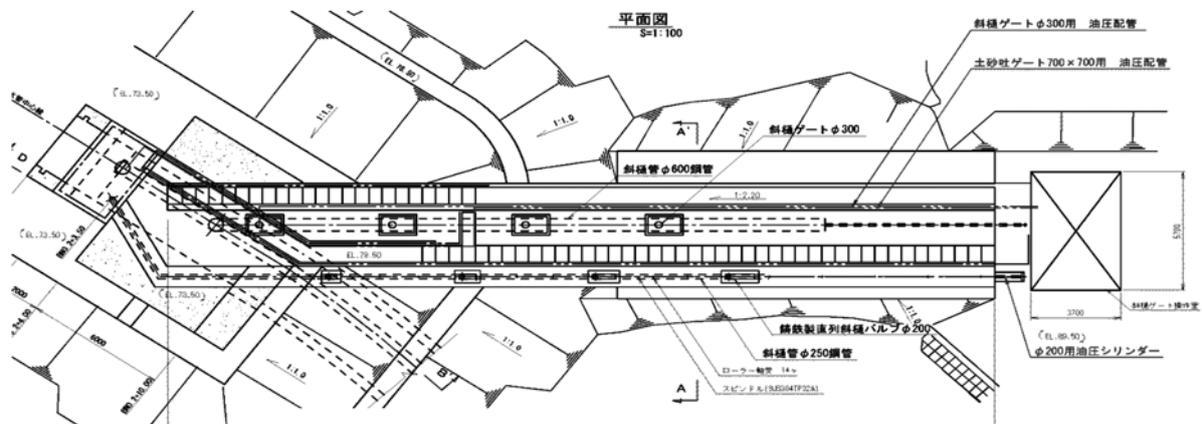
斜樋平面図 (油圧配管・油圧シリンダー)
